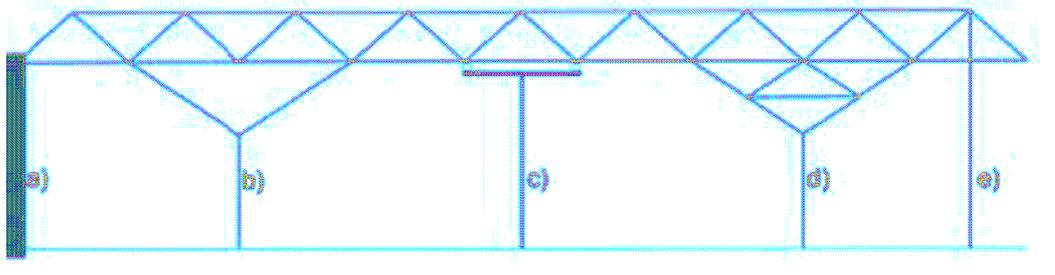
Tipos de apoios: a) apoio direto no banzo inferior; b) apoio do tipo pirâmide invertida; c) apoio com viga de transição; d) pirâmide invertida com travejamento interno; e) apoio direto no banzo superior.
